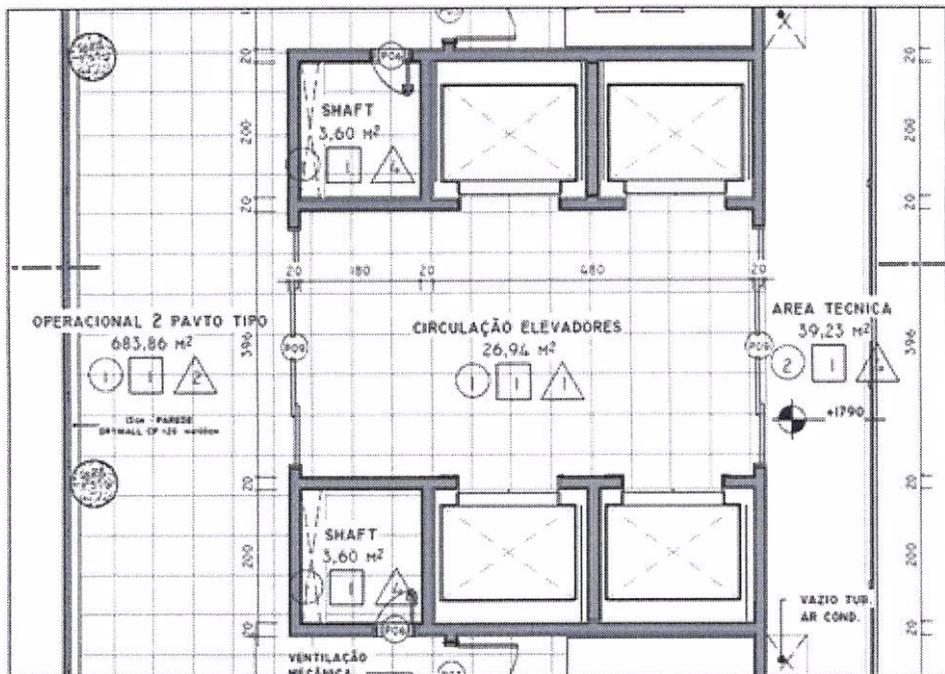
Projeto Arquitetônico folha 3 - Planta do pavto intermediário, do 1 pavto, pavto 2 ao 5 tipo e pavto gabinete.
